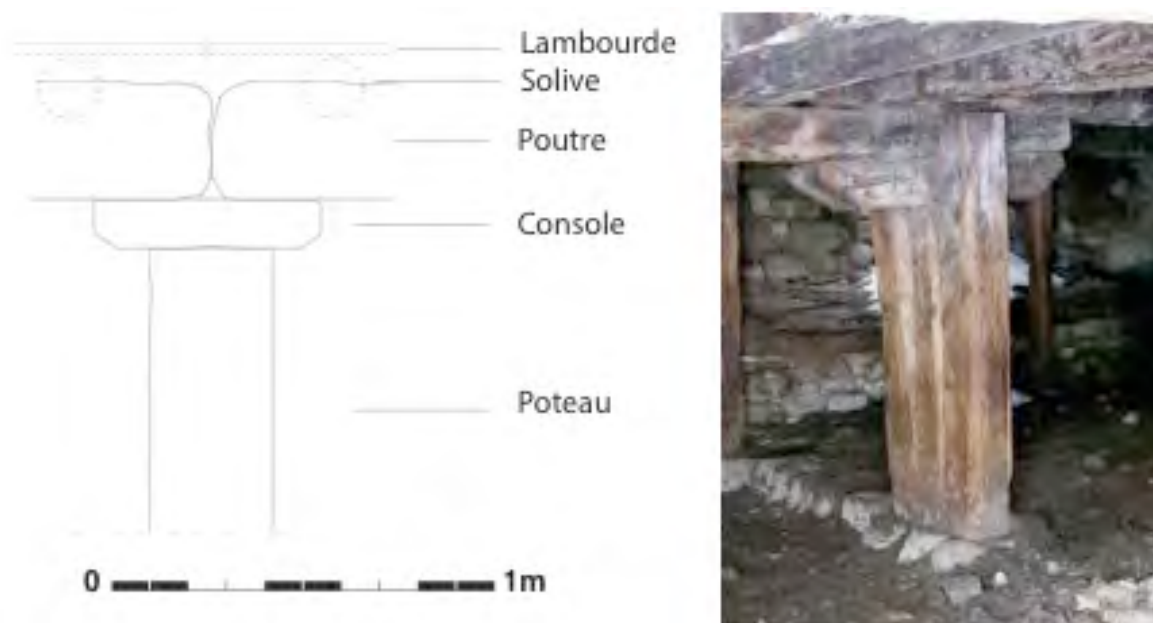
Coupe d'un poteau (poteau sud, travée orientale) dans le bâtiment CR 100 (à gauche) dans le hameau de Champrichard (Allos, 04) et cliché d'un poteau formé de trois pièces de bois et surmonté d'un chapeau biseauté (Vacheresse, Allos). Cl. et DAO de V. Labbas.
